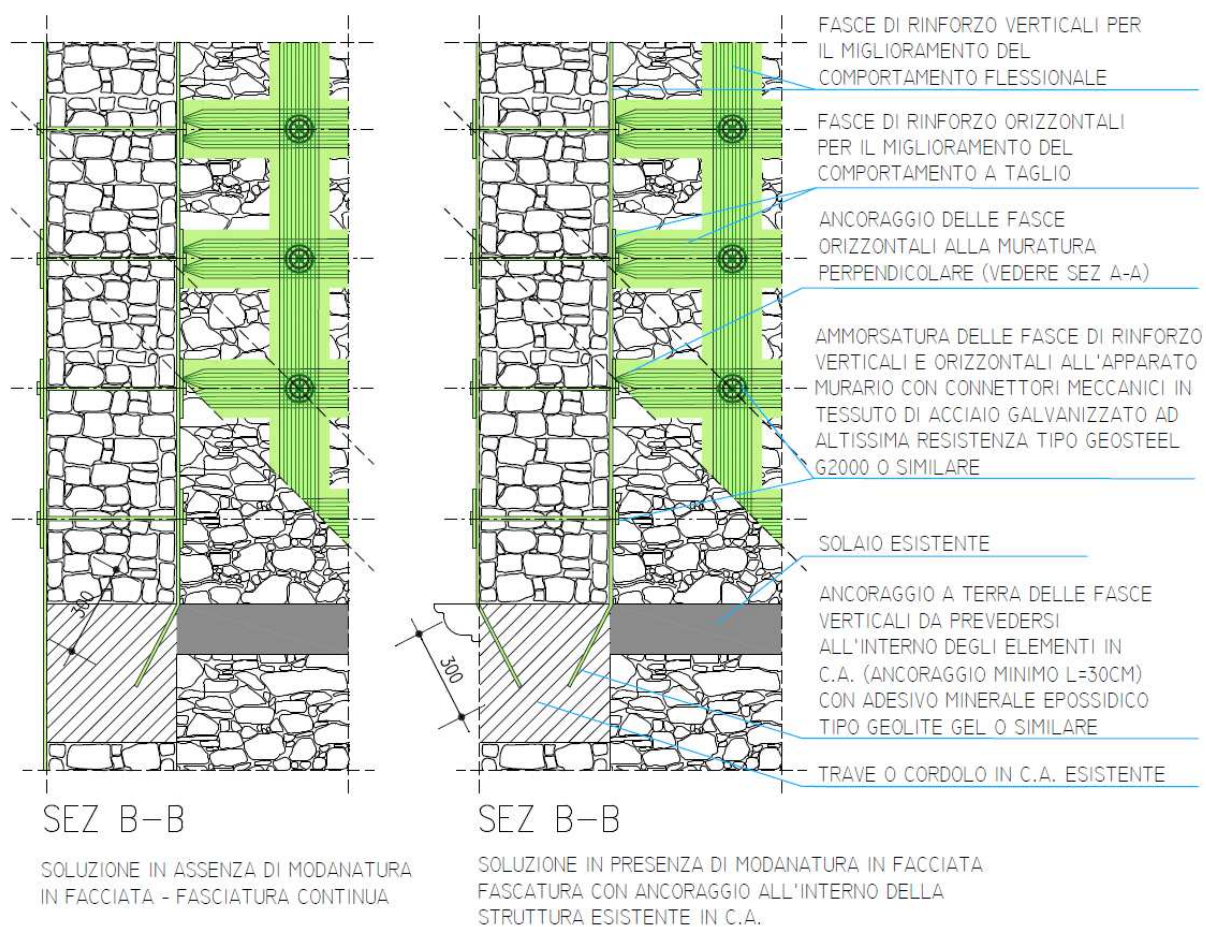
pianta rinforzo a taglio e flessione con tessuti in fibra di acciaio su muratura, sez. d'angolo e interna
